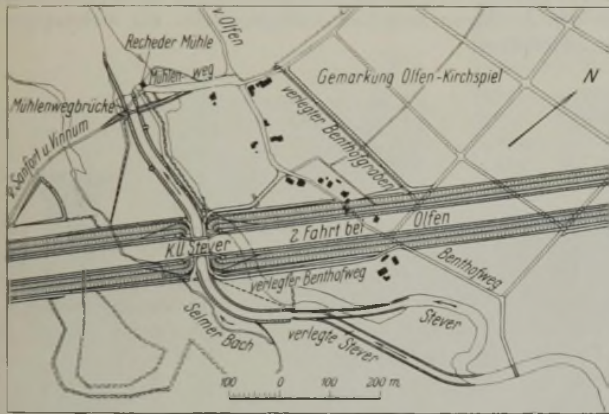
Lageplan der Kanalüberführung Stever mit Verlegung der Stever, des Selmer Baches und des Benthofweges.
